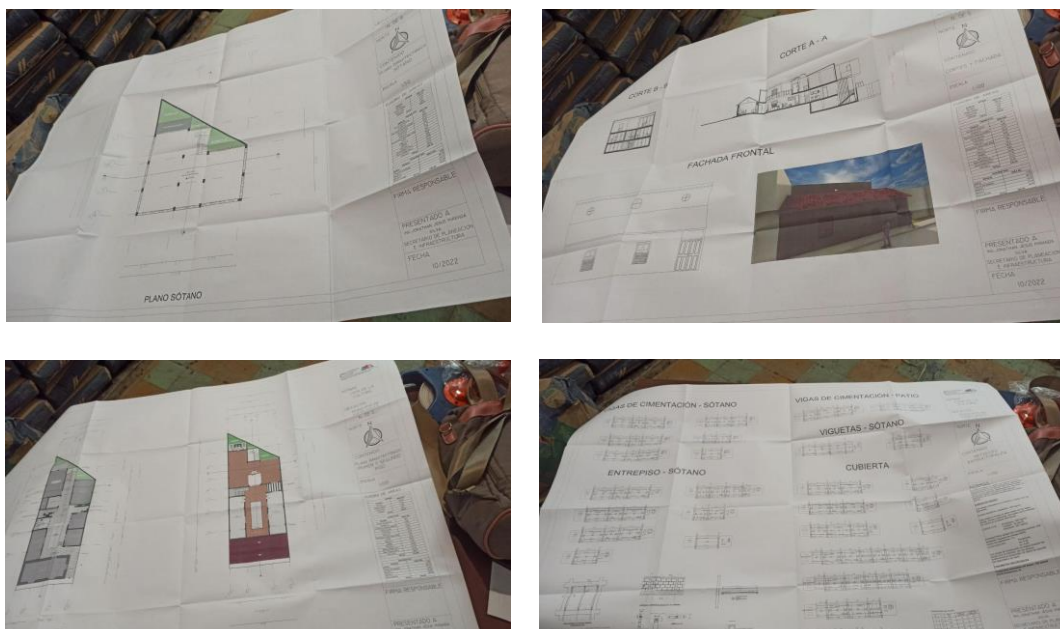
Planos actualizados, segunda etapa del proyecto. Los planos arquitectónicos y estructurales fueron ploteados por la empresa OBRAAMBIENTE S.A.S.
